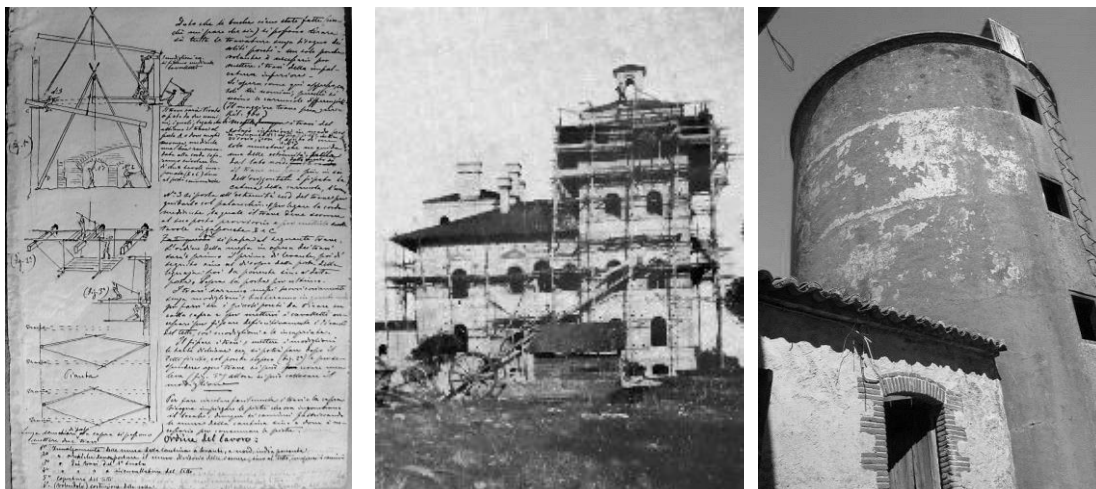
Castelo de Pavone (Piemonte), planeamento do estaleiro, s.d., in APFA; Fig.5 – Casa de Font’Alva (Alentejo), fotografia de estaleiro, c.1896, in APFA; Fig 6 – Font’Alva, construções rústicas e silos em betão armado (c. 1900), fotografia da autora, 2007.
